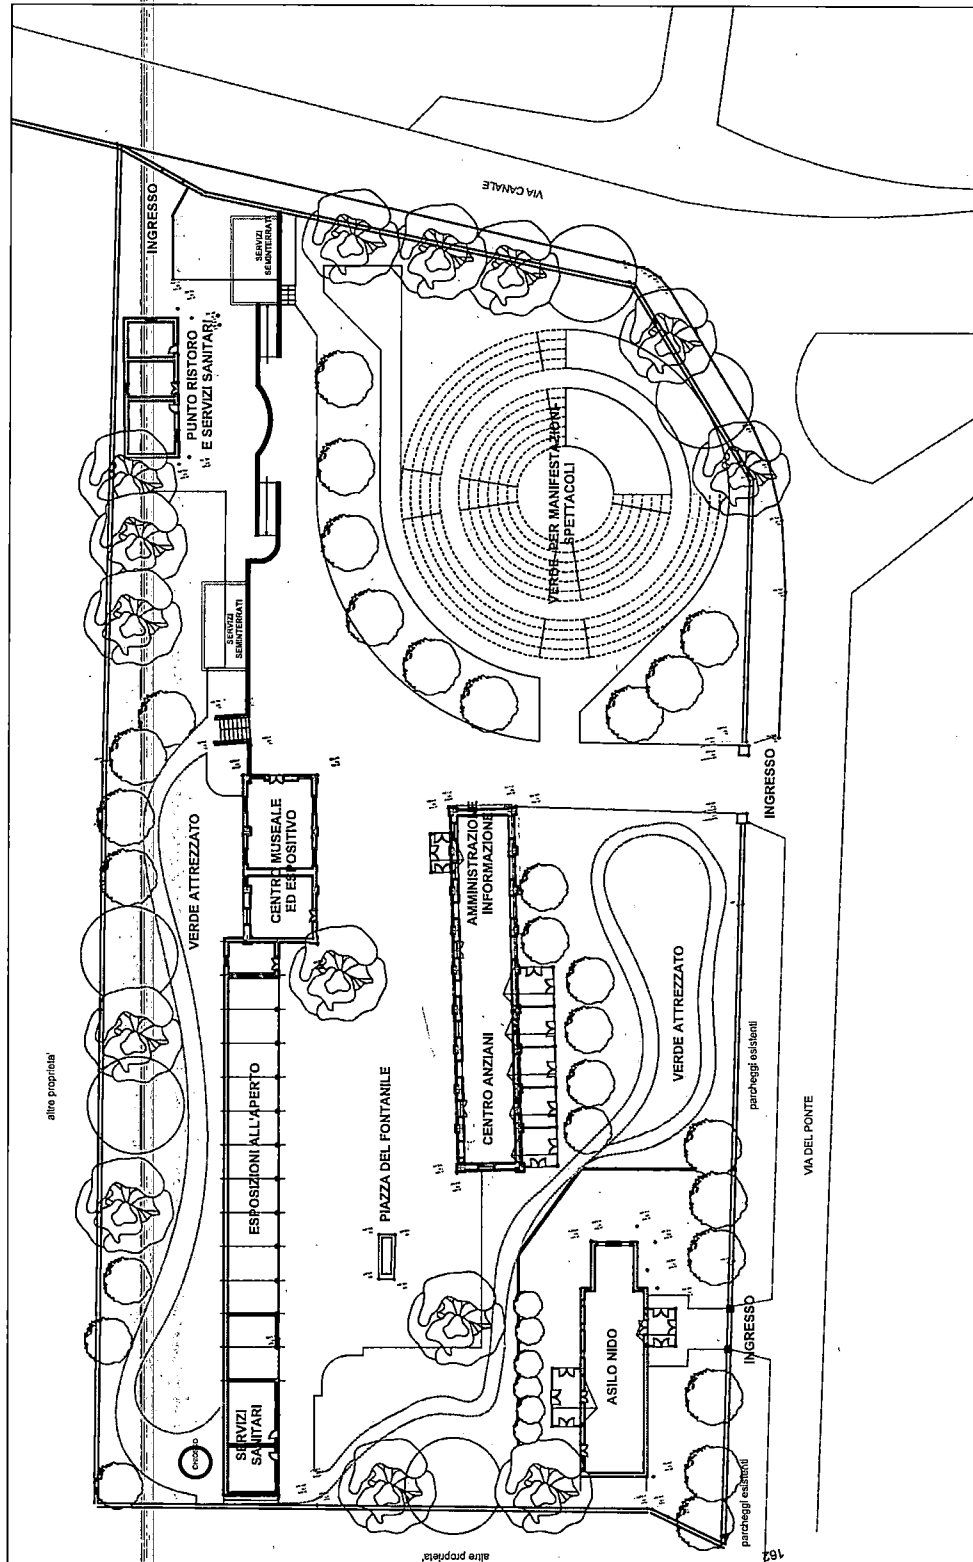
Ex Distaccamento Vedette - Esempificazione progetto
